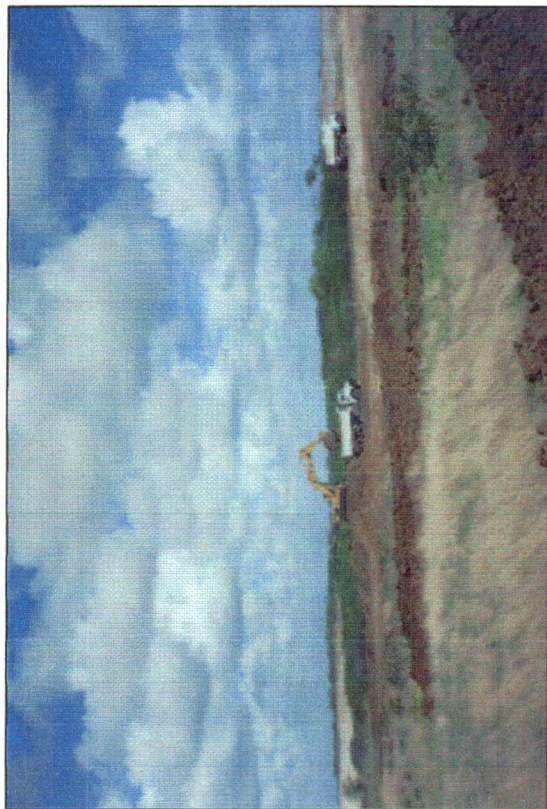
Vista da jazida terrosa em exploração.
